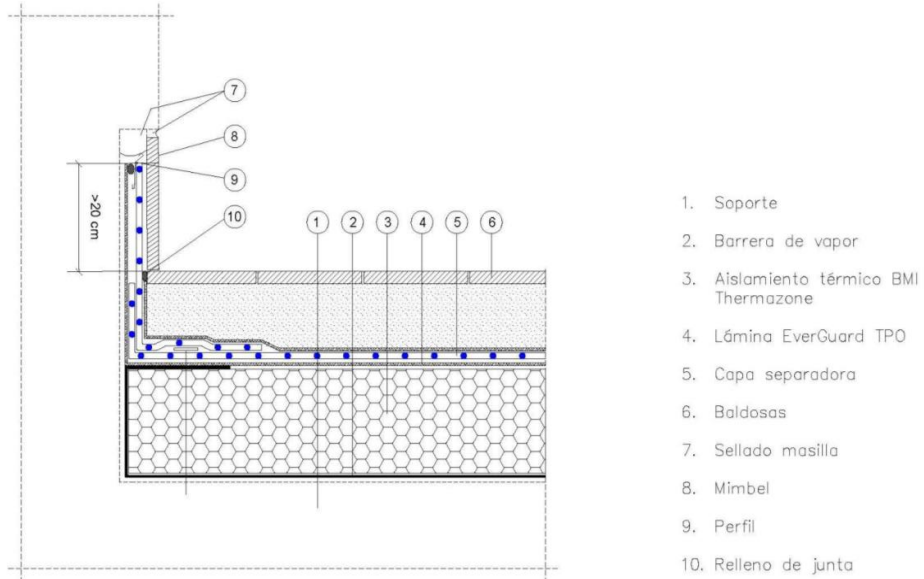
Detalle remate peto con perfil en forma de ángulo
